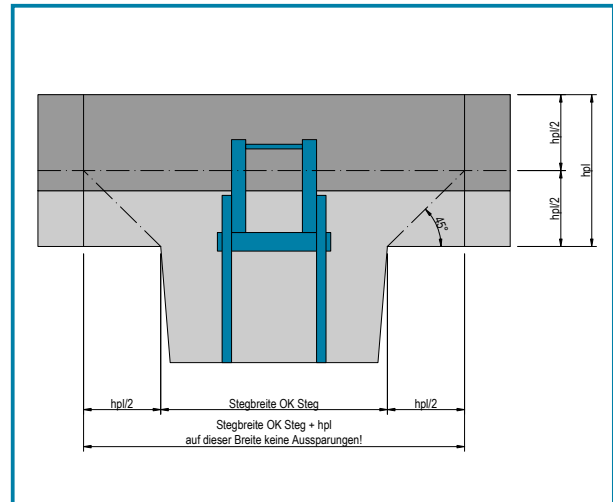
Teilflächenpressung bei Ortbeton C20/25
